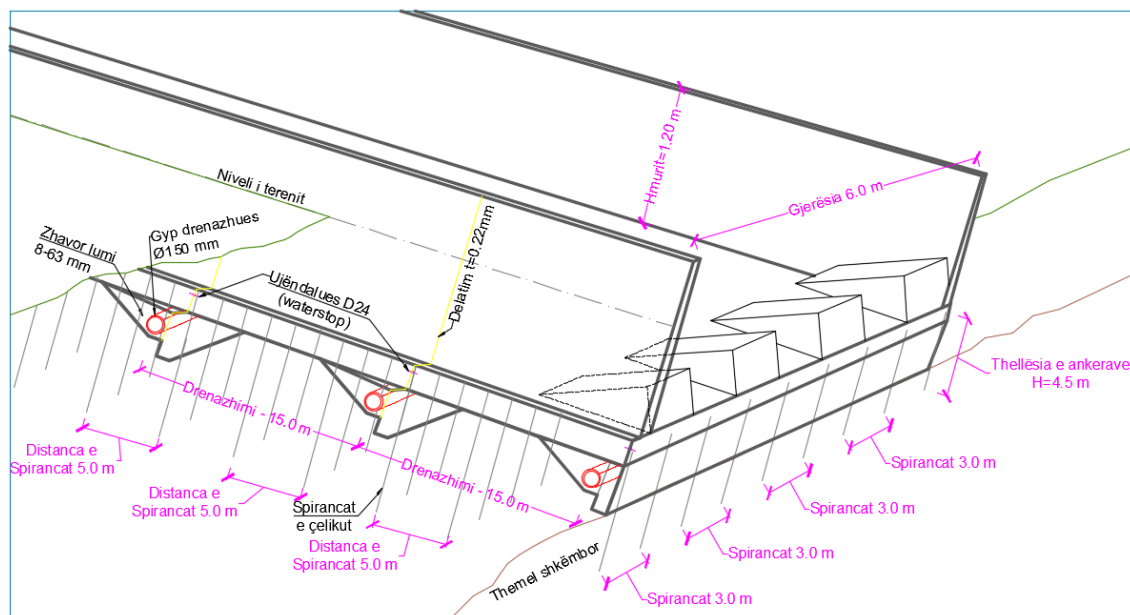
Detali konstruktiv i drenazhimit dhe bazamentit të kapërderdhësit.
